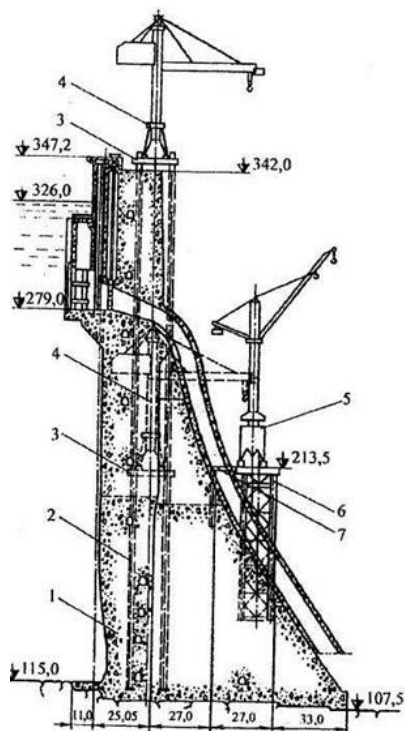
Схема размещения кранов на Саяно-Шушенской ГЭС с башенными кранами КБГС-1000 на самоподъемной эстакаде
